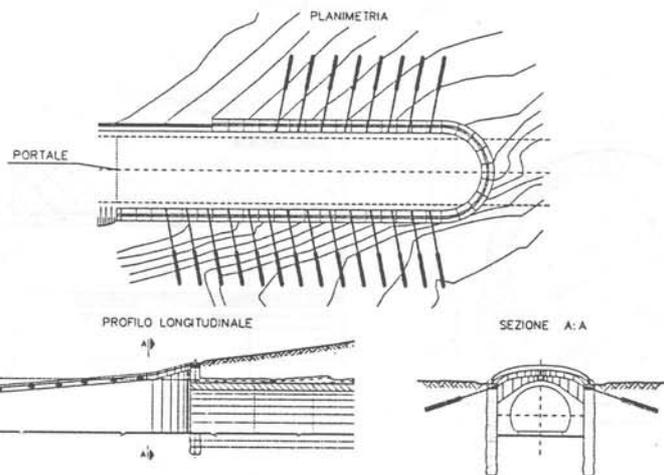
Planimetria, profilo longitudinale e sezione dell'imbocco lato Bari della galleria Madonna del Carmine.
